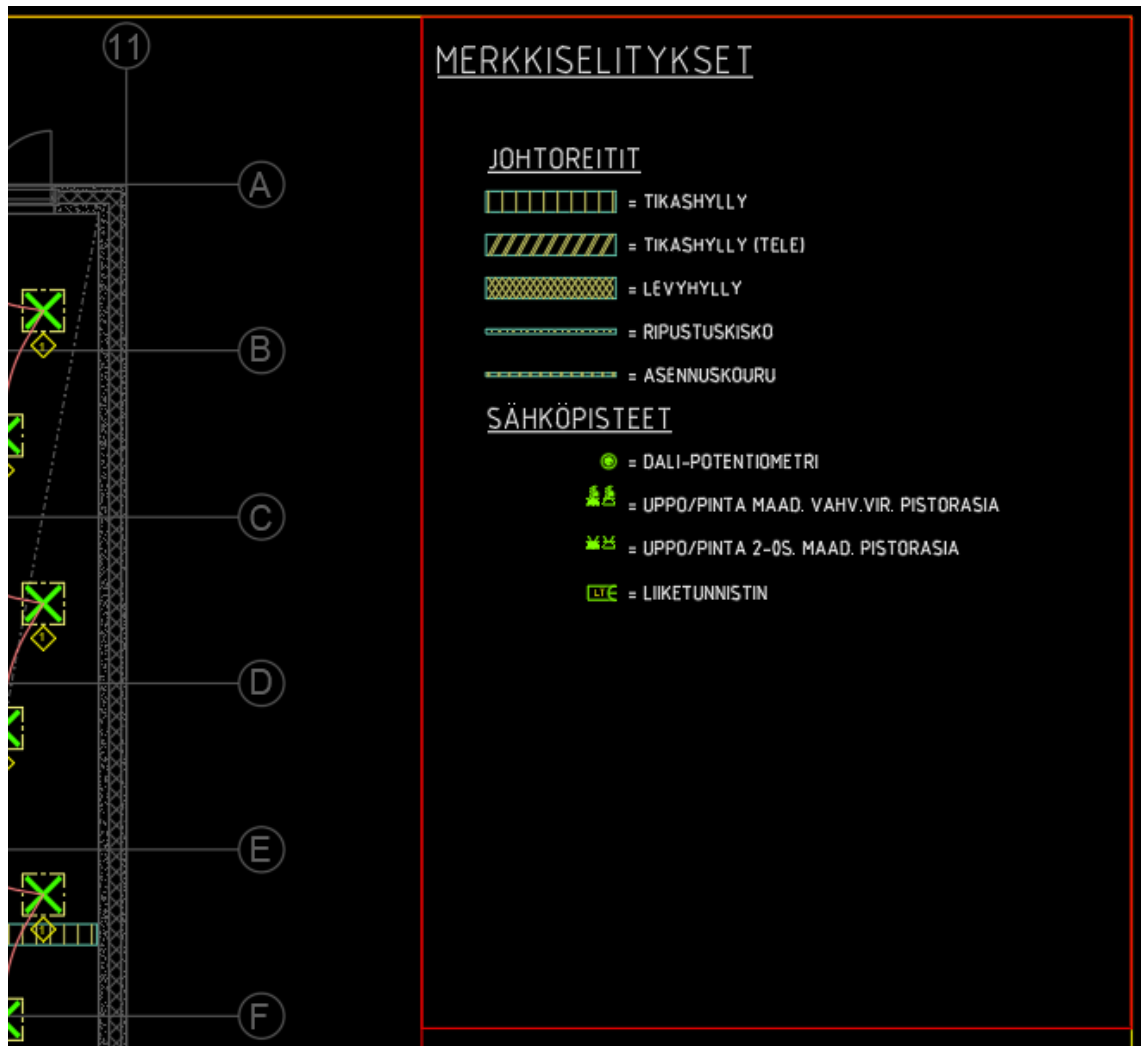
Draw Cable Markings -työkalu [11; 15].
